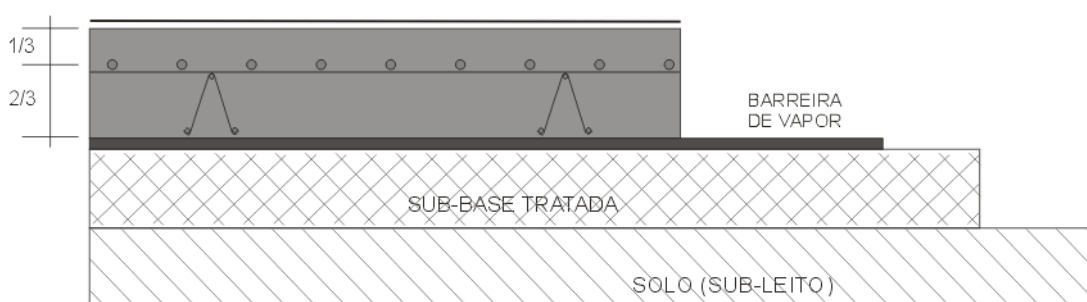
Placa de concreto cm armadura distribuída continuamente (Fonte: PETRONILHO e SÍGOLO, 2011)
